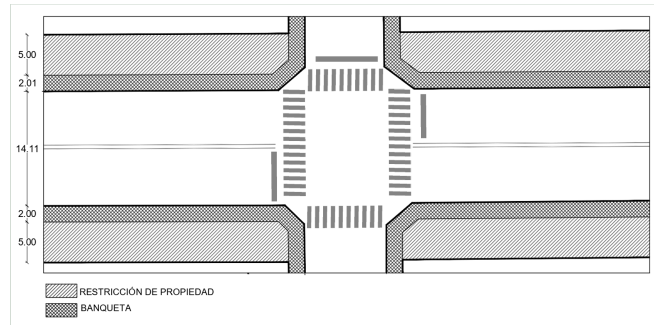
Dimensiones de la calzada Sur. Fuente: Elaboración propia (2021)
